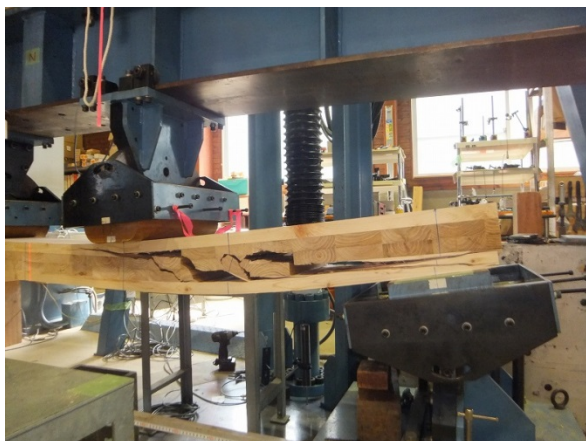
3層 4ply 強軸の破壊状況 2
